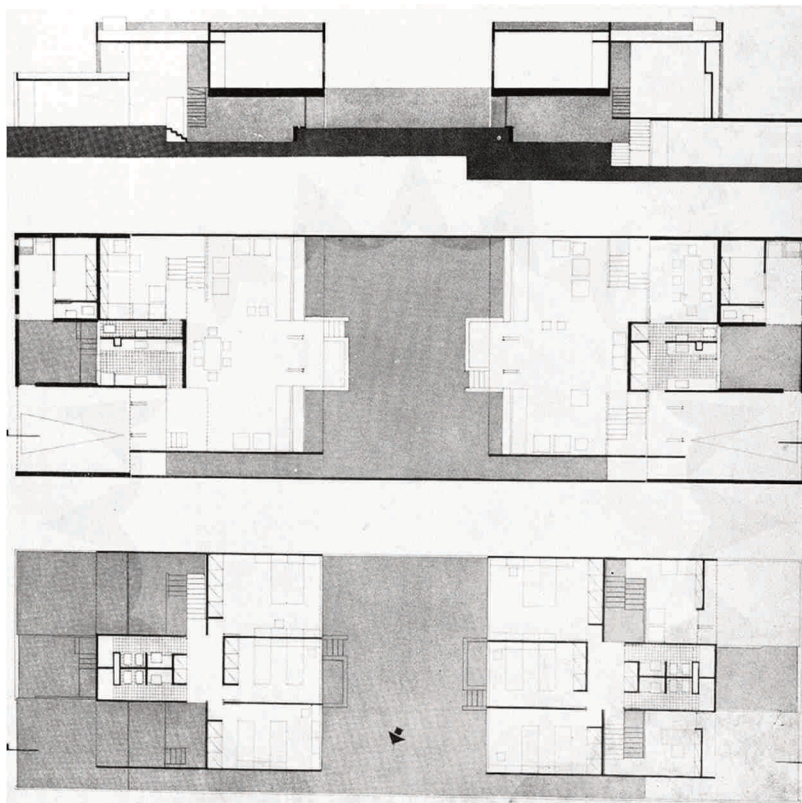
Secção longitudinal, planta do pavimento térreo e planta do pavimento superior das Residências Marieta (à direita) e Ruth Vampré (à esquerda). O jardim central integra as duas casas, subvertendo o conceito de espaço urbano. Fonte: Revista Acrópole nº 319
